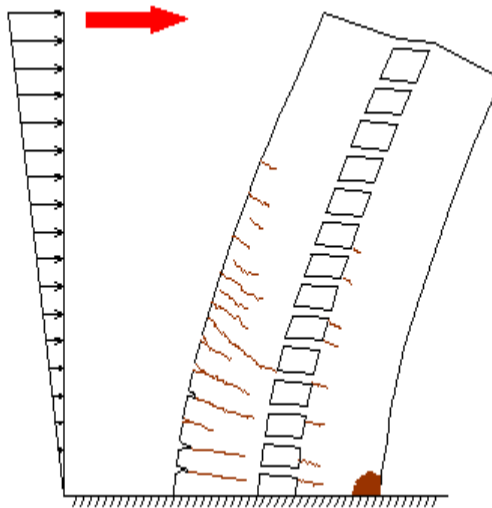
Falla por Acción Rígida de las vigas de conexión.
